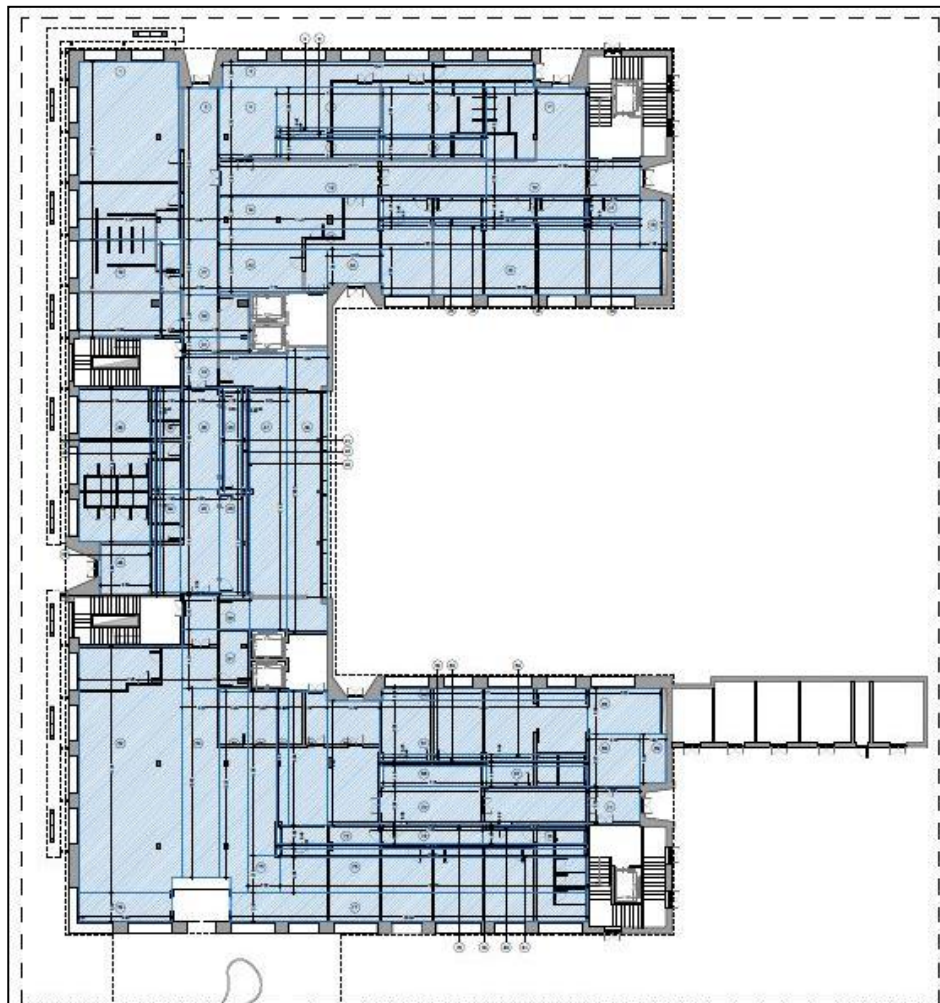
Verifica superficie lorda – pianta piano terra (T.16)
